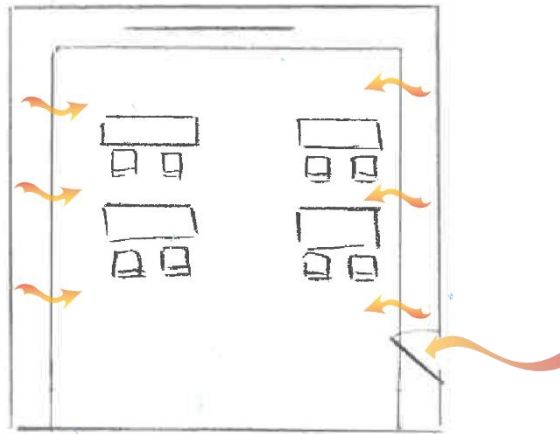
Grundriss: Abhangdecke mit Lüftungsschlitzen
